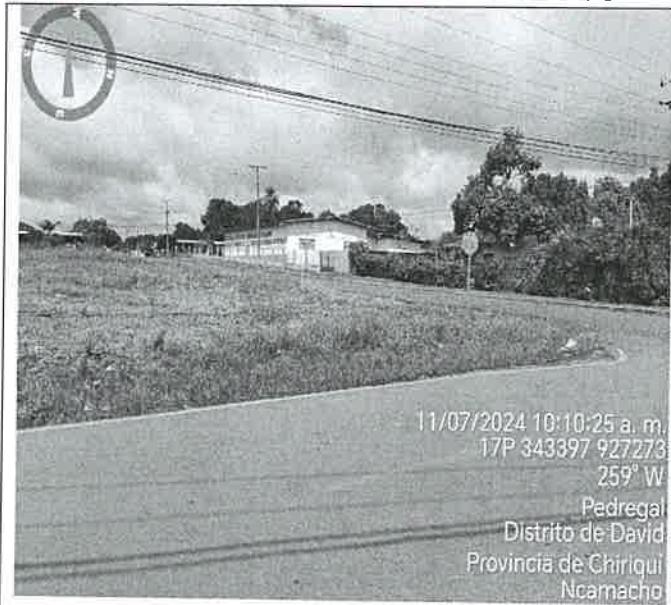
Vista lateral izq. del área a desarrollar y la colindancia con calle asfaltada.
